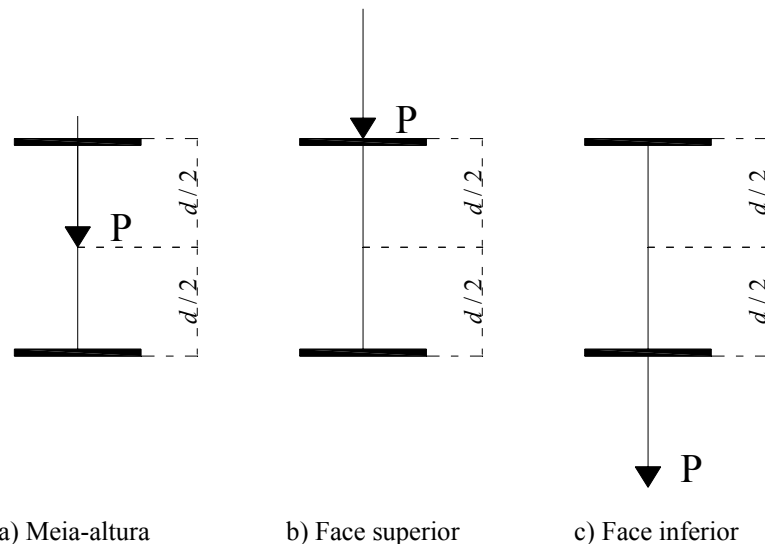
Níveis de aplicação das cargas transversais na seção transversal das vigas estudadas
